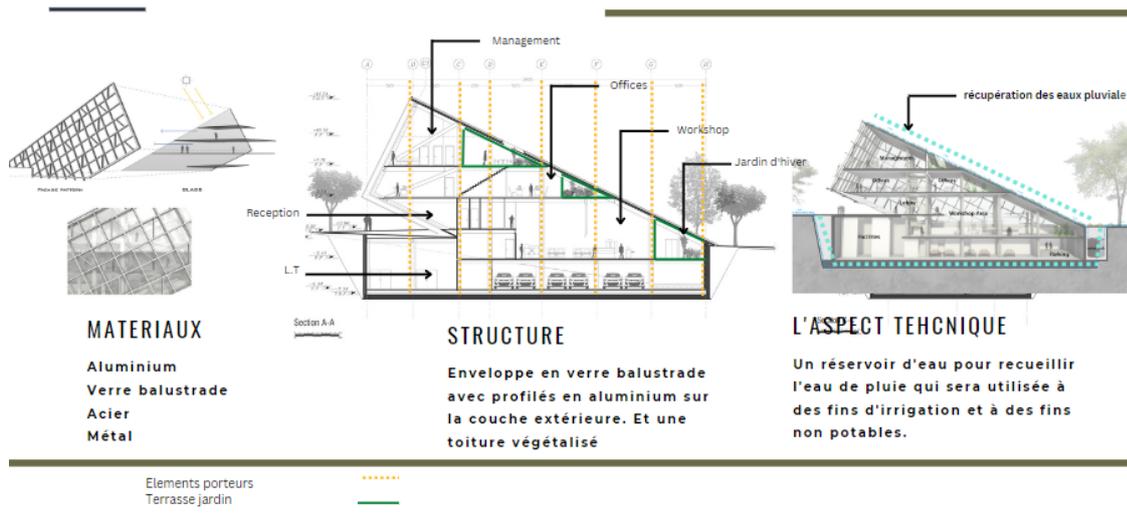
Schéma explicatif de la structure du bâtiment, Source: Auteur
